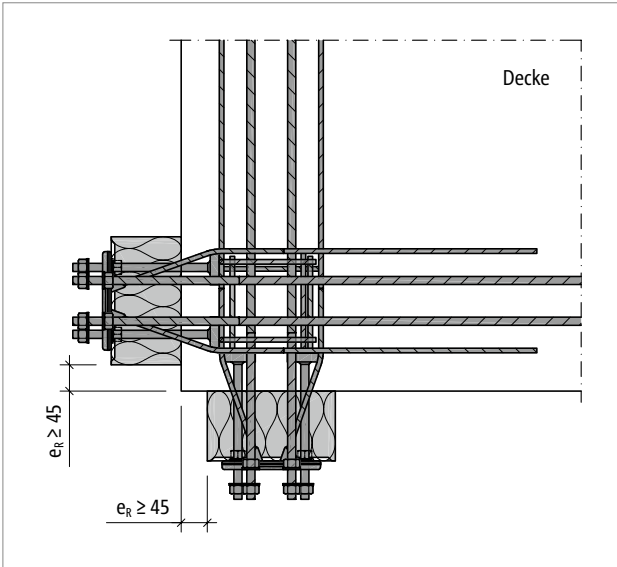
Schöck Isokorb® XT Typ SK: Randabstände an der Außenecke bei senkrecht zueinander angeordneten Isokorb®
